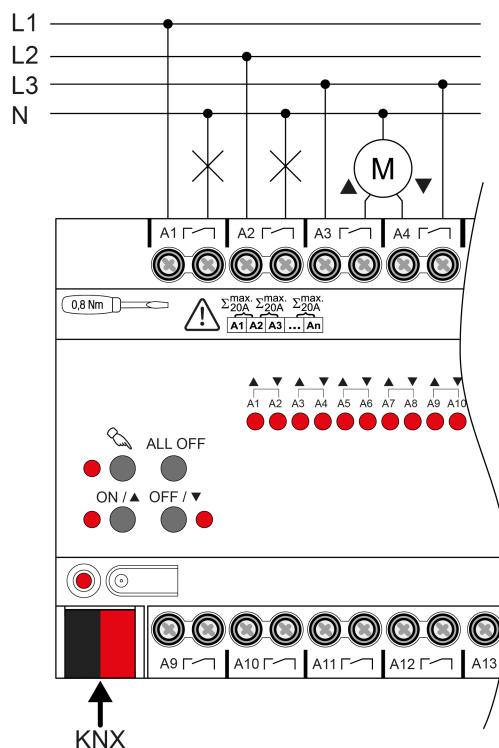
Conexión del dispositivo (ejemplo de conexión)
